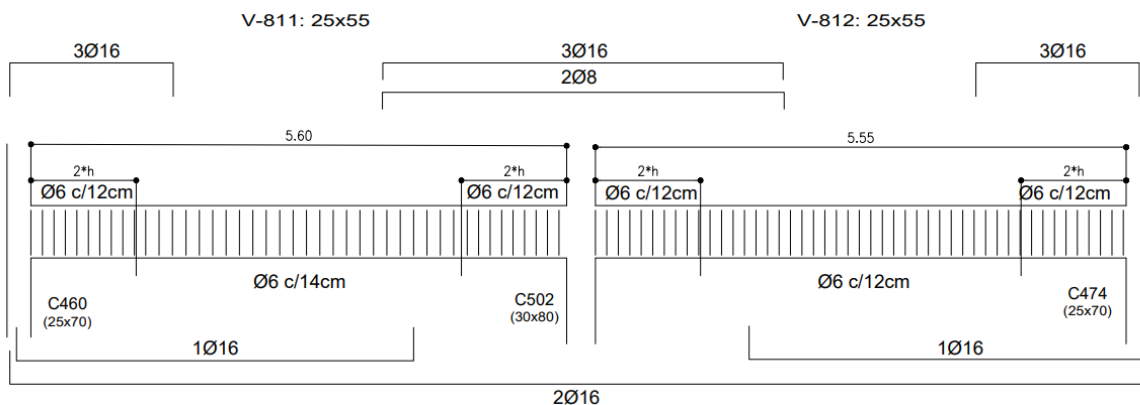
Esquemas de armaduras - Vigas 811 y 812
